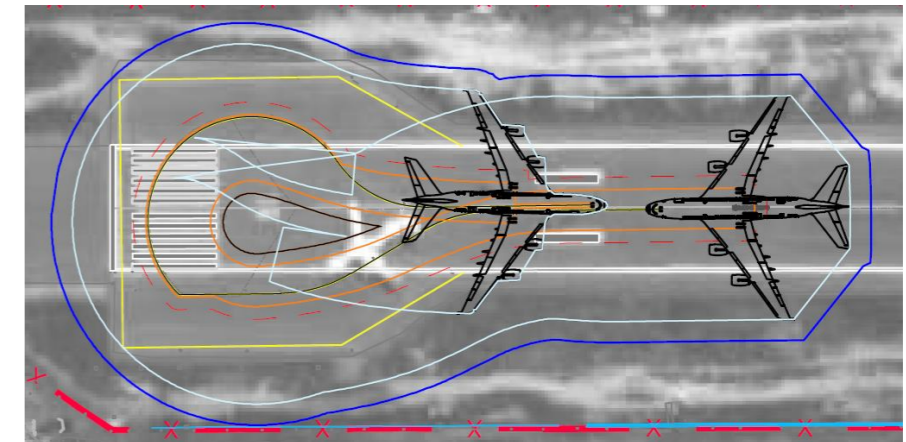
Sobre ancho del pavimento en calle DELTA
